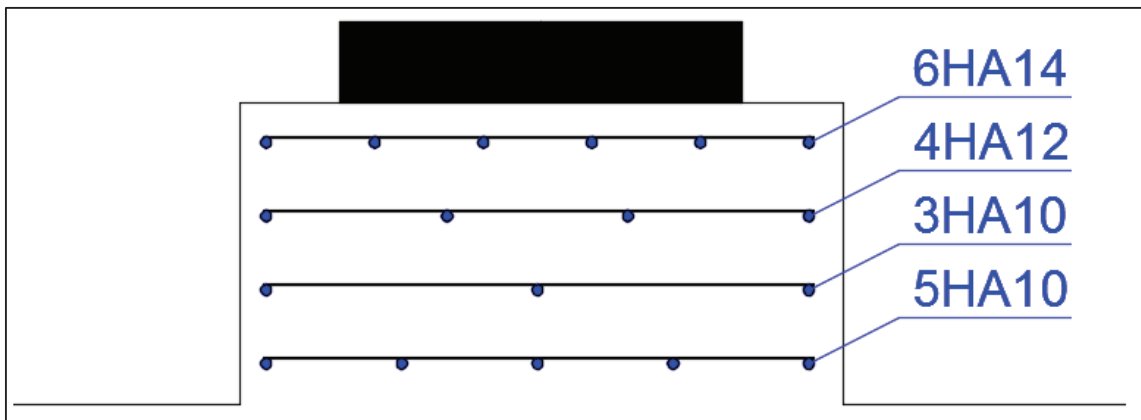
Ferrailage du dé d'appui au niveau de la culée.
